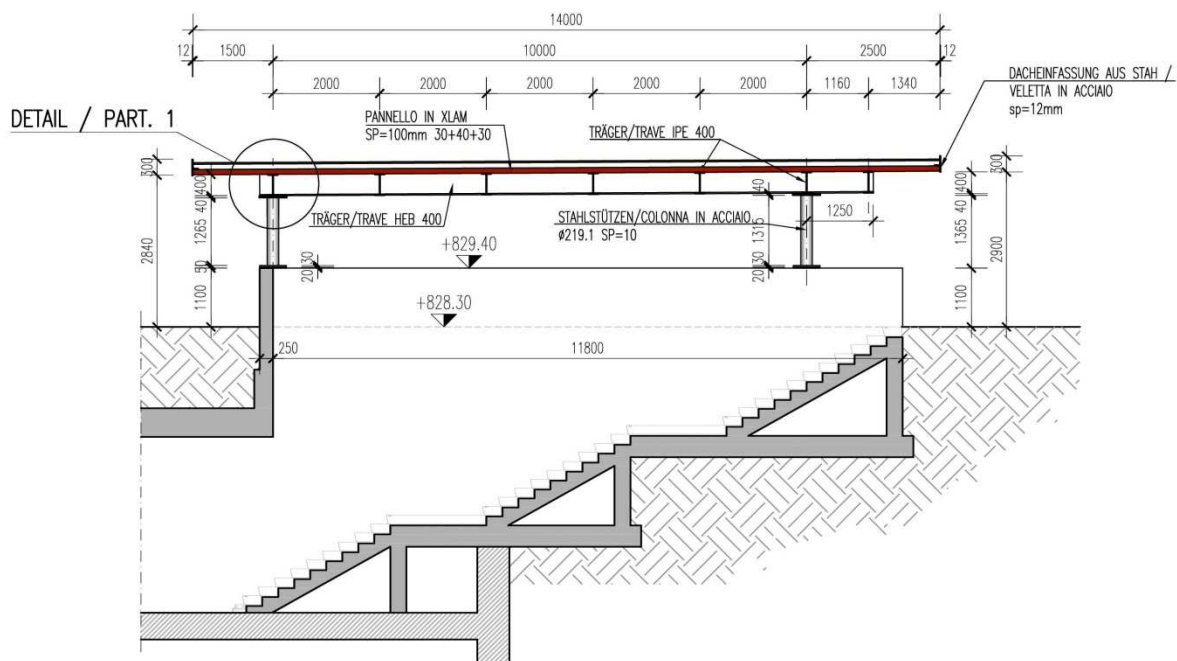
Sezione tipo della copertura rampa di accesso al sottopasso di stazione di massima altezza
